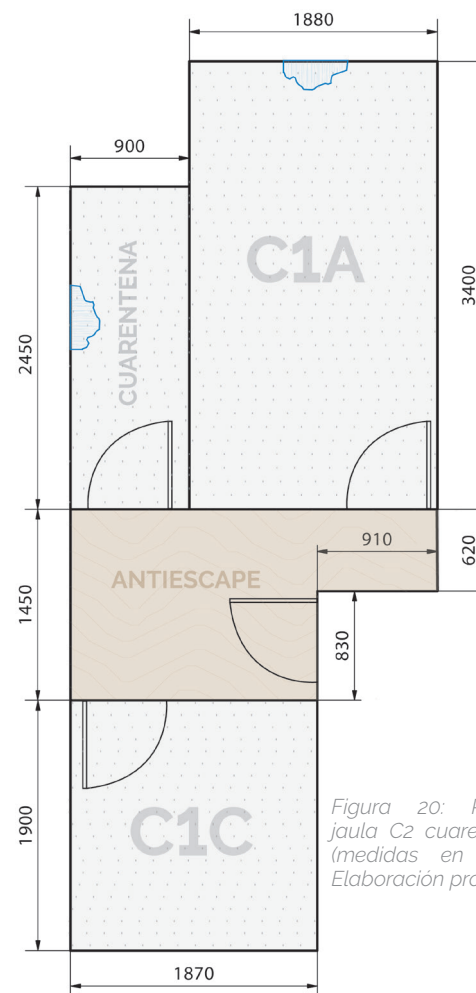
Planta jaula C2 cuarentena (medidas en mm). Elaboración propia
